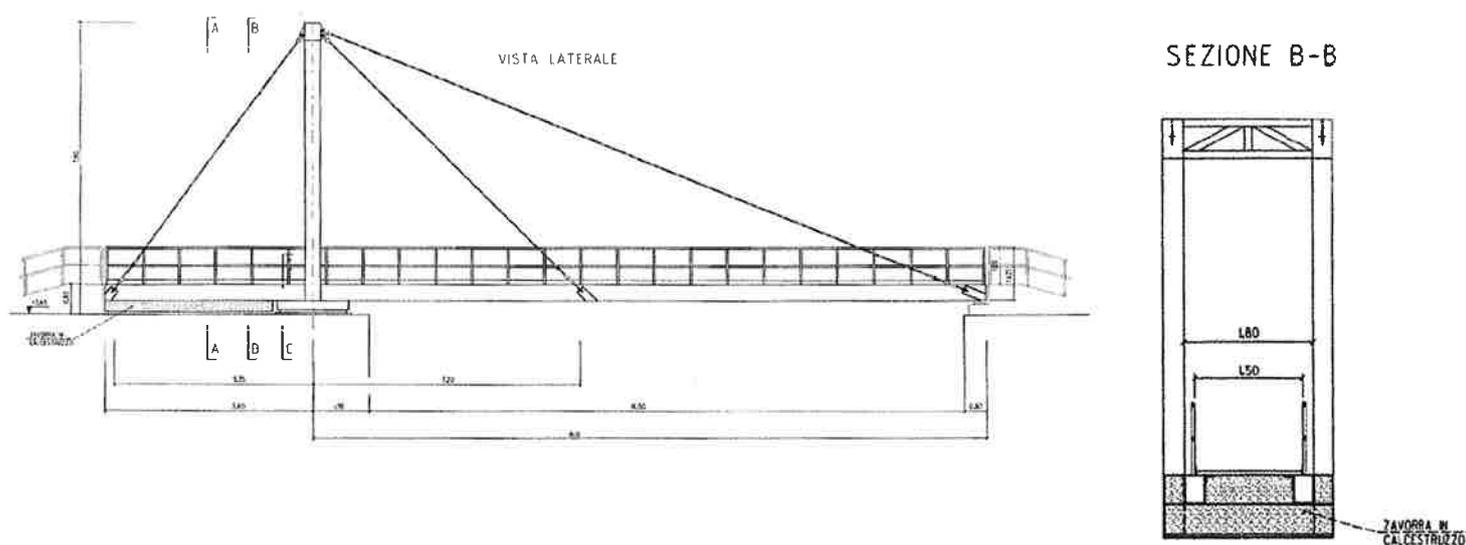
VISTA LATERALE E SEZIONE TRASVERSALE DEL PONTICELLO GIREVOLE PREVISTO IN PROGETTO DEFINITIVO
